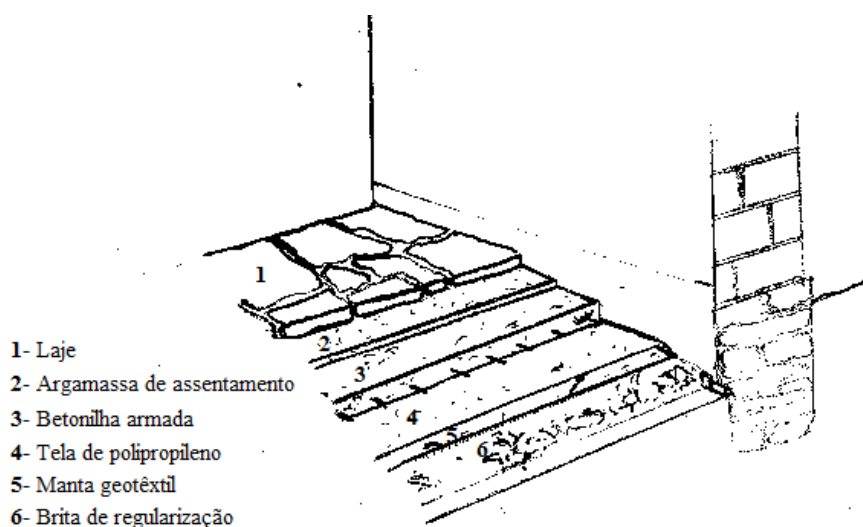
Reabilitação e reforço de pavimento interior com acabamento em lajeta de pedra, (Fonte: de autor)
